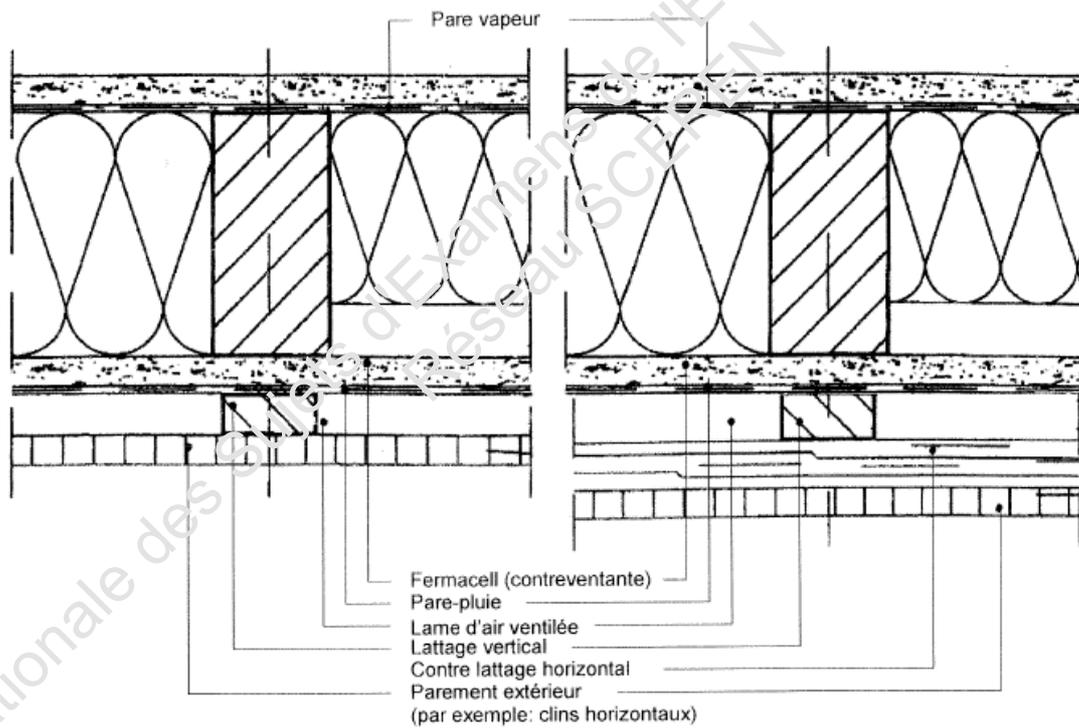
Mur extérieur bardage rapporté – Coupe horizontale
